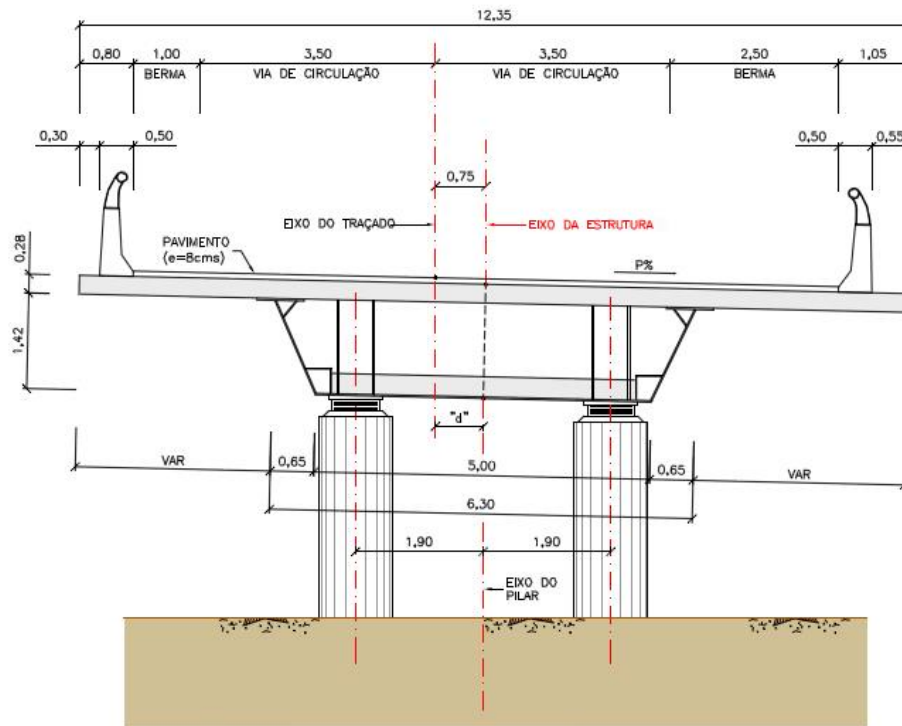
Secção transversal da Ponte Fornells em zona de apoio
